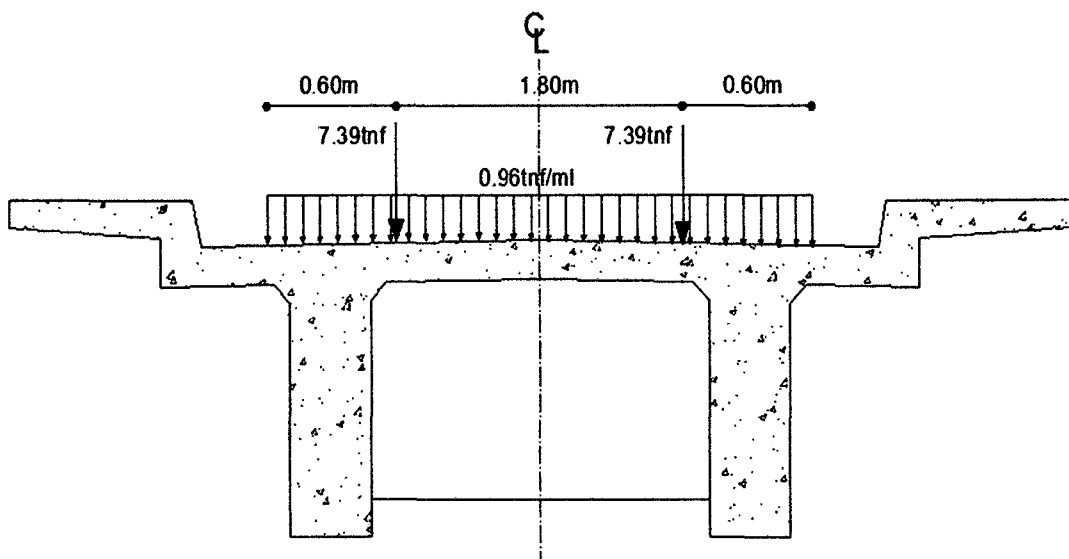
Ubicación de la carga móvil centrada sobre la viga diafragma - Para el Primer y Tercer Tramo.
